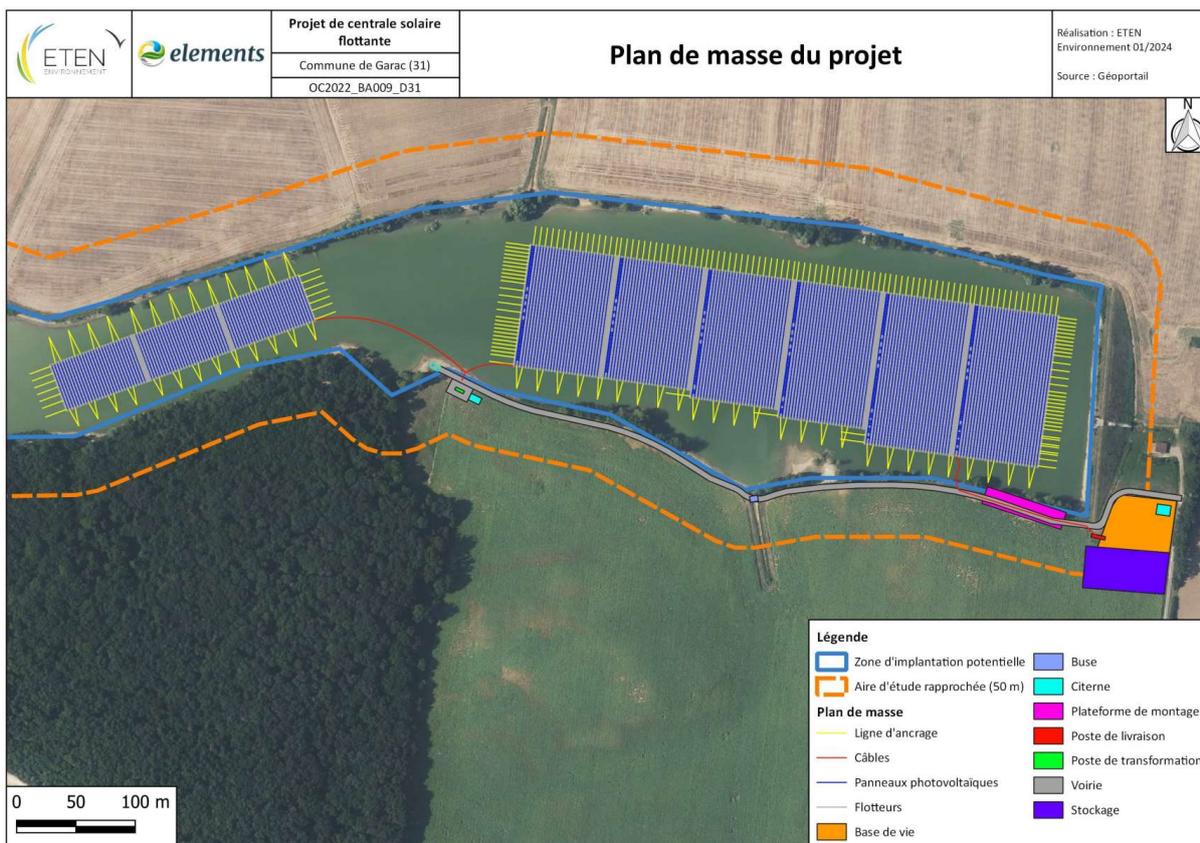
Plan d'implantation du projet photovoltaïque (source : Elements France)
